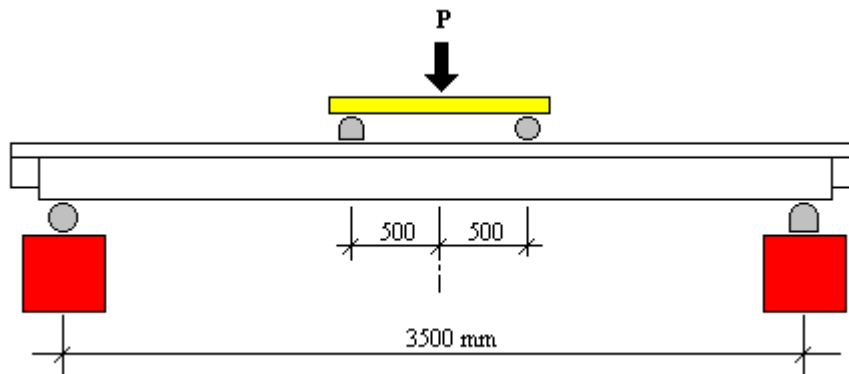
Seção Longitudinal das Vigas Ensaçadas e Esquema do Ensaio
